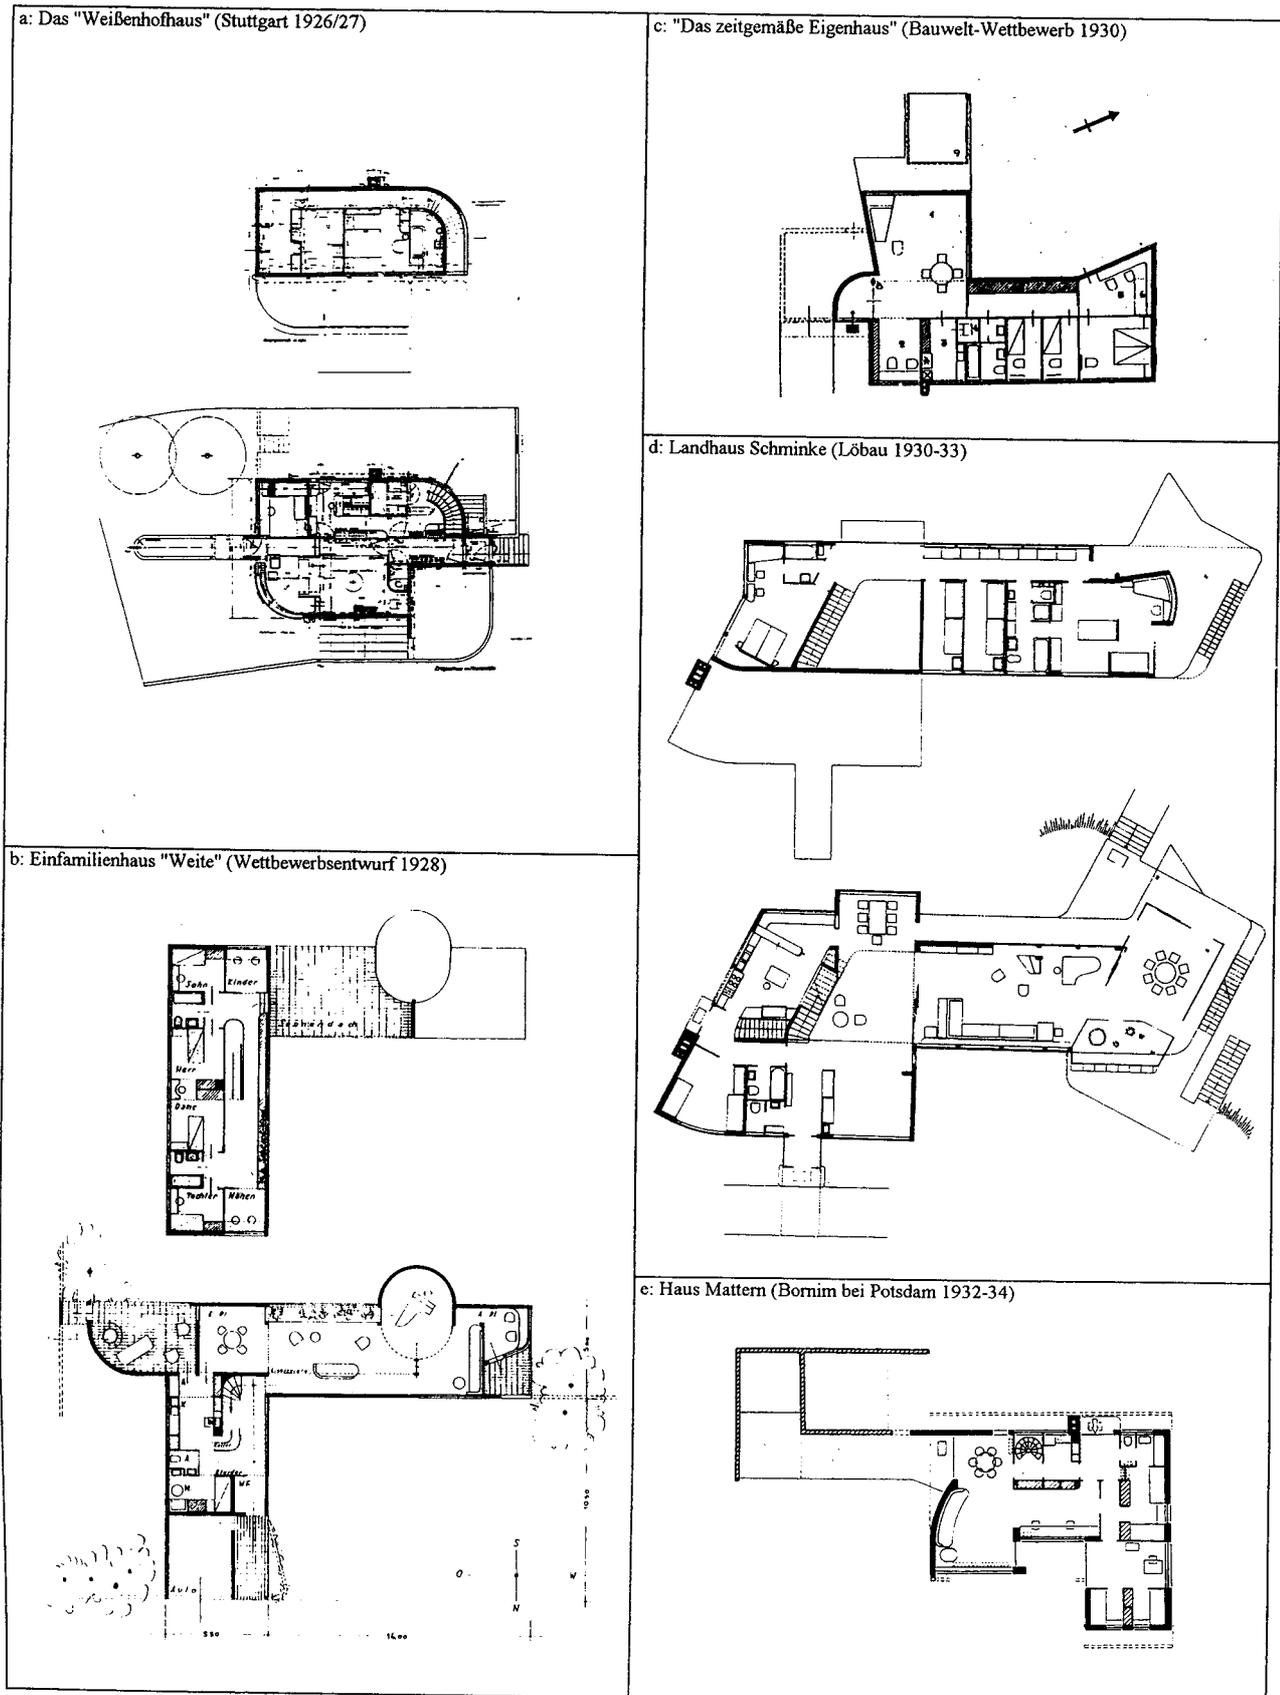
a-e: Einfamilienhausgrundrisse von Scharoun 1926-34, M 1:400
